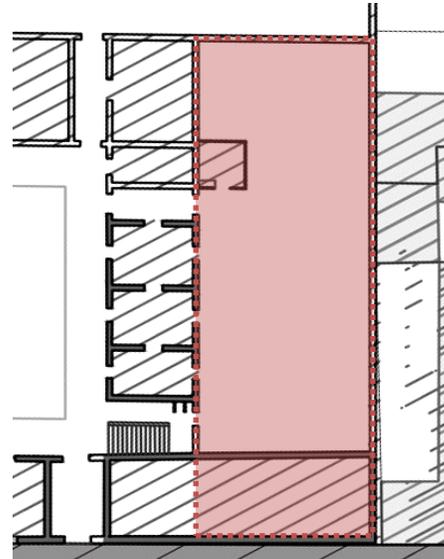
Identificación de estado de predio en 1910, en rojo polígono parroquia. Fuente plano base: Fondecyt "Reconstrucción planimetría Santiago 1910.")
